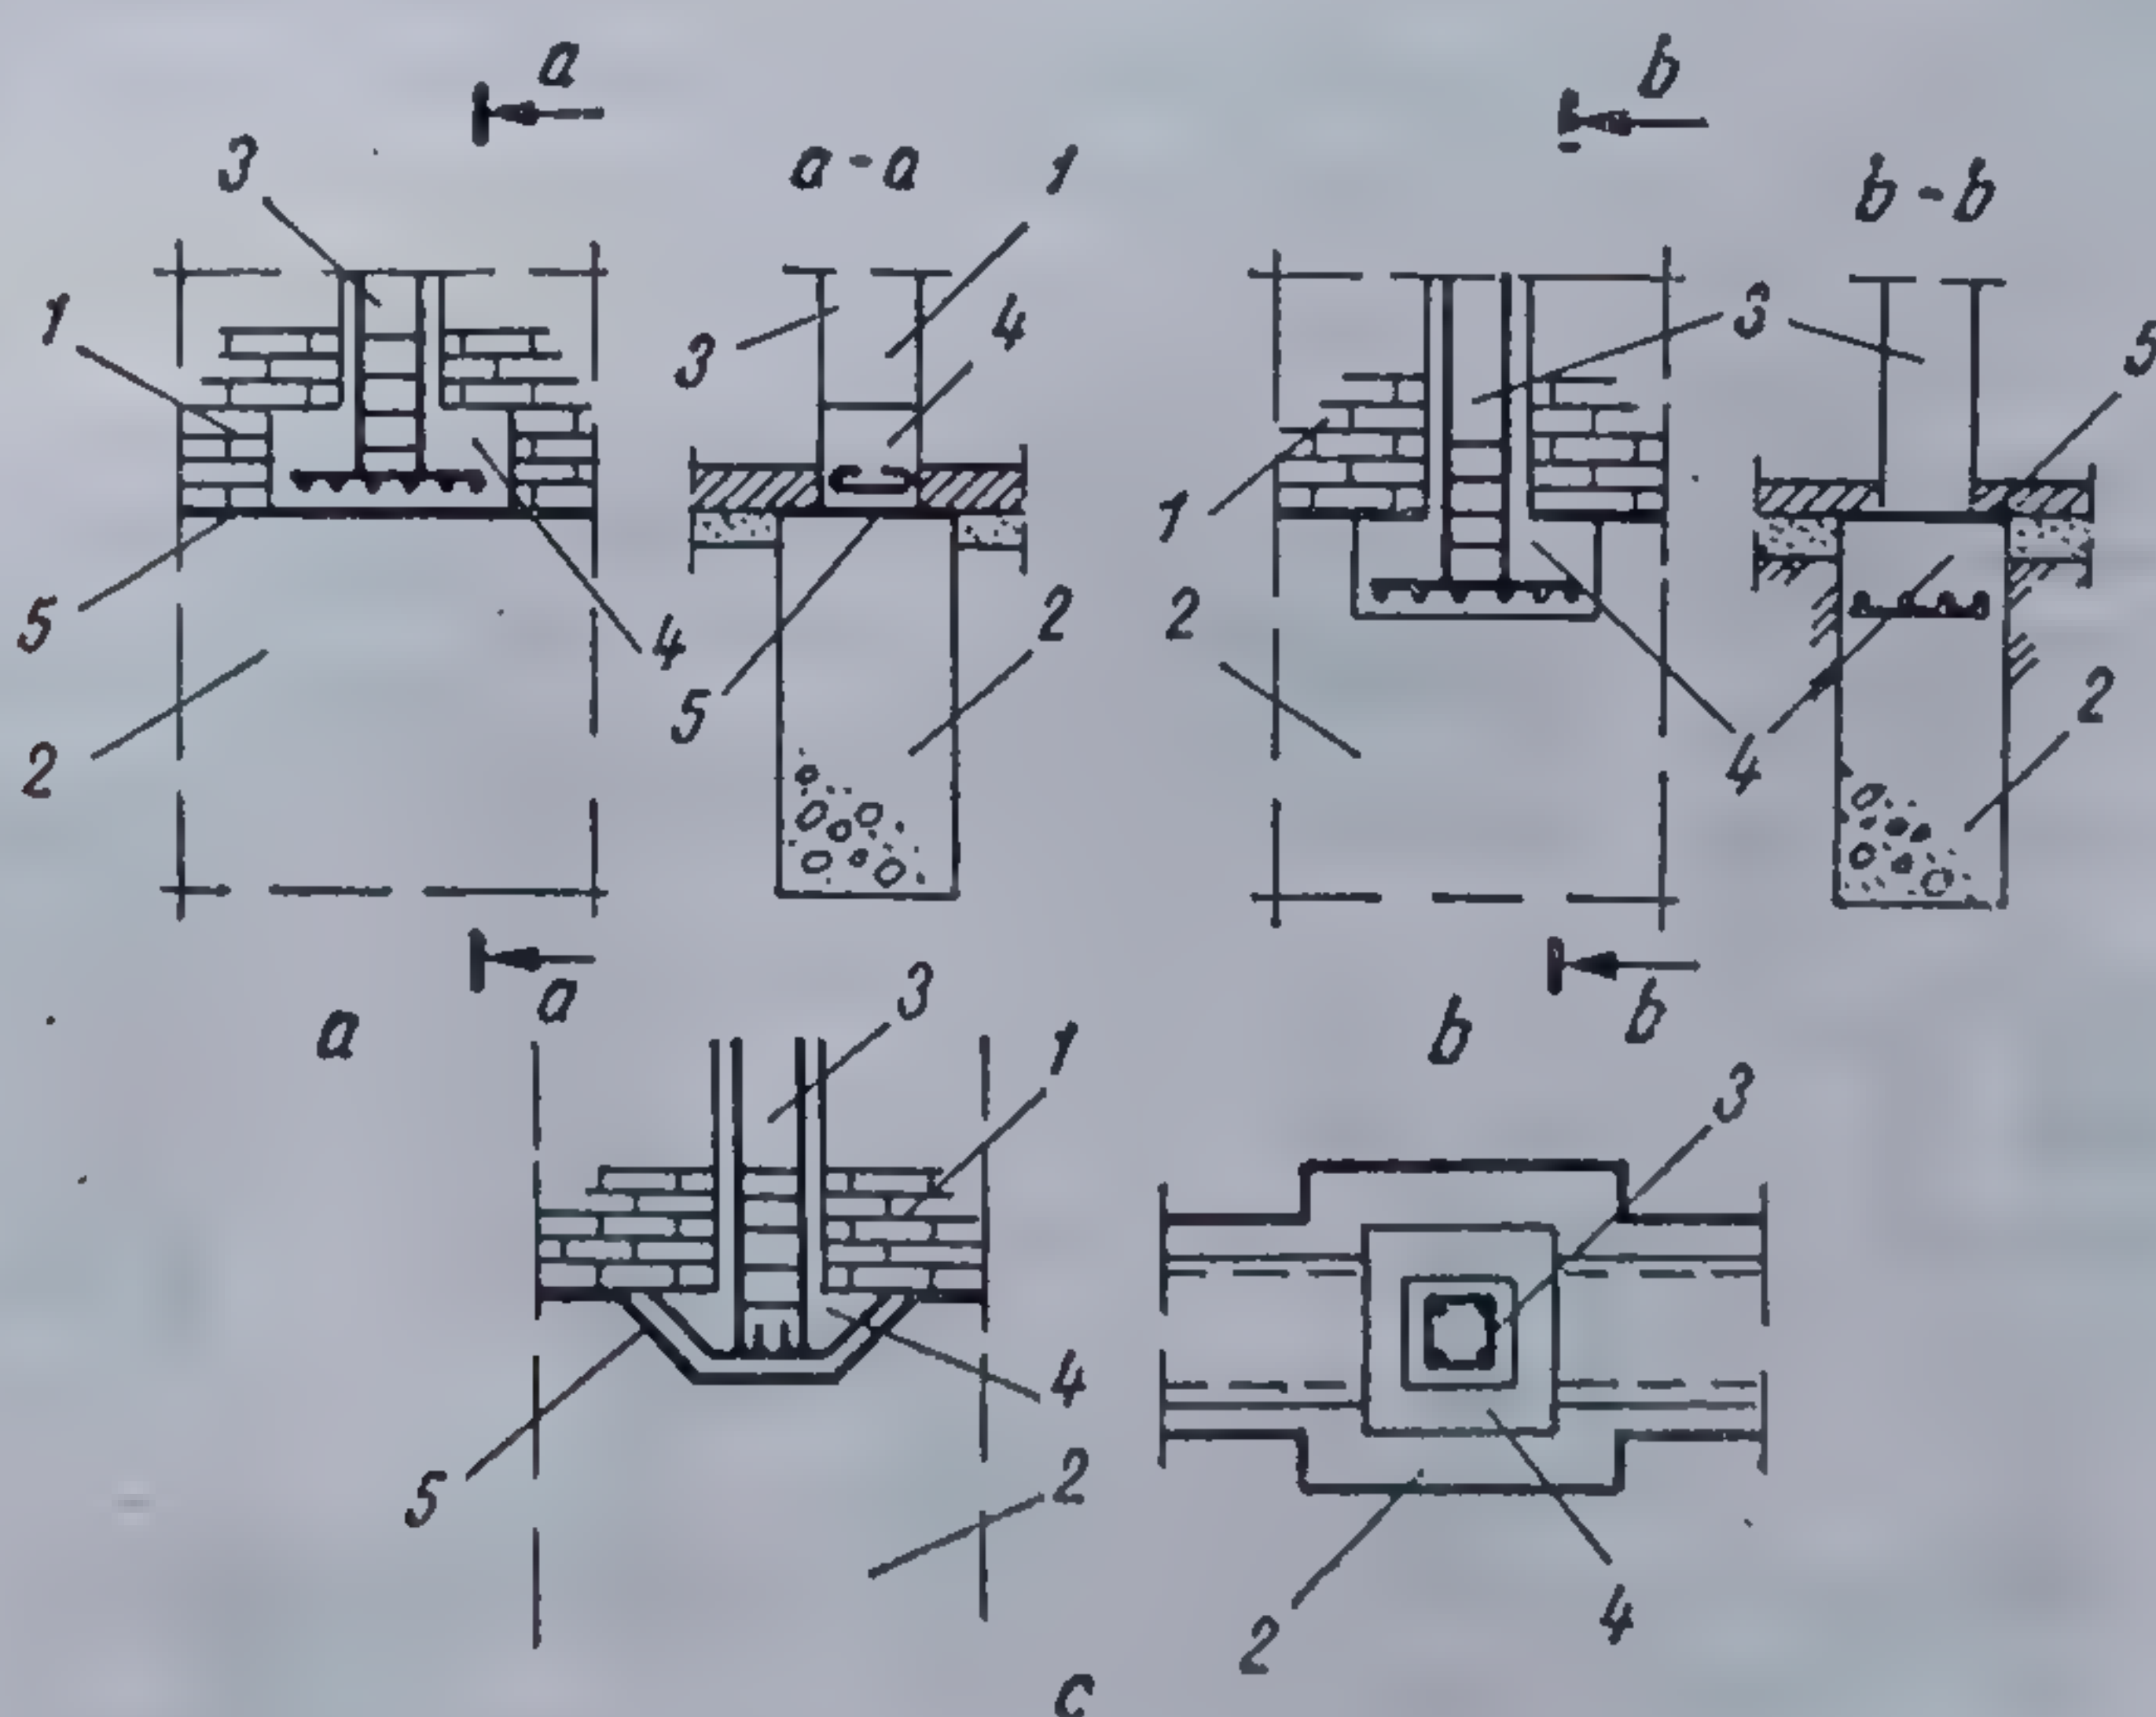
Detalii de fundare pentru simburile din beton armat :
